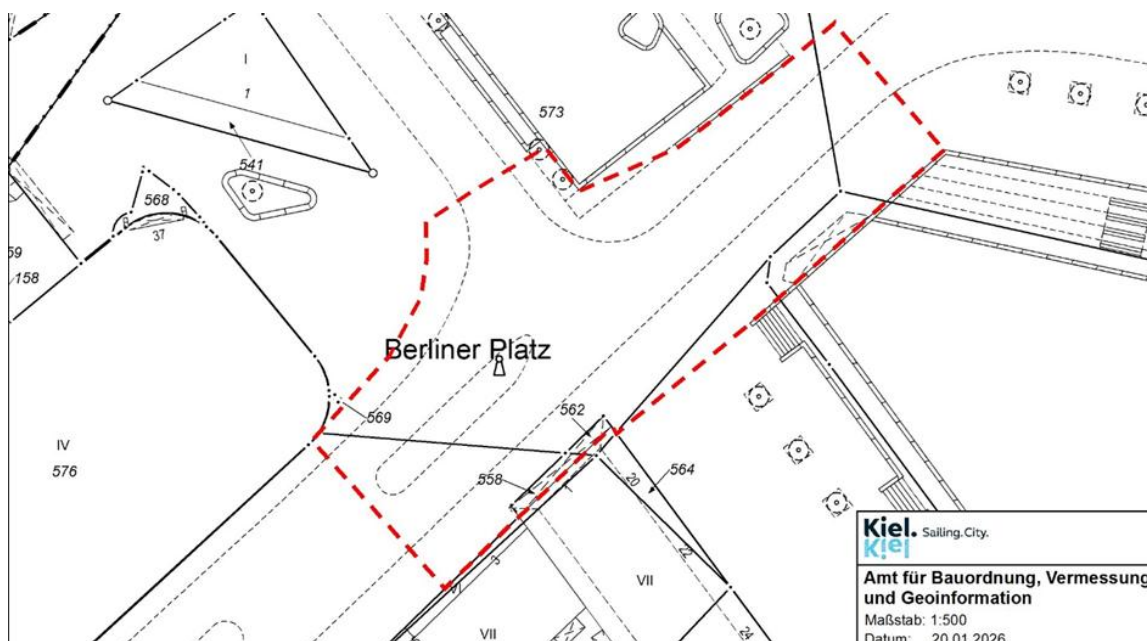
Planungsumgriff Berliner Platz/ Wall
